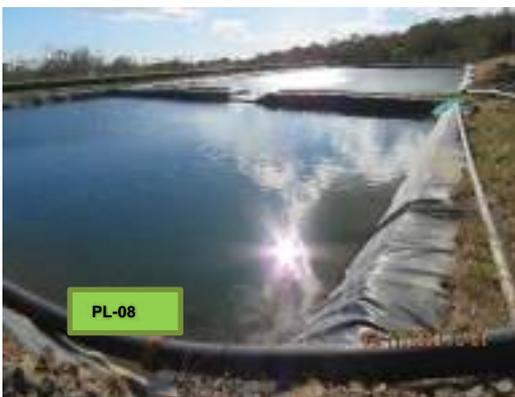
Lagunas impermeabilizadas en el campo geotérmico.
